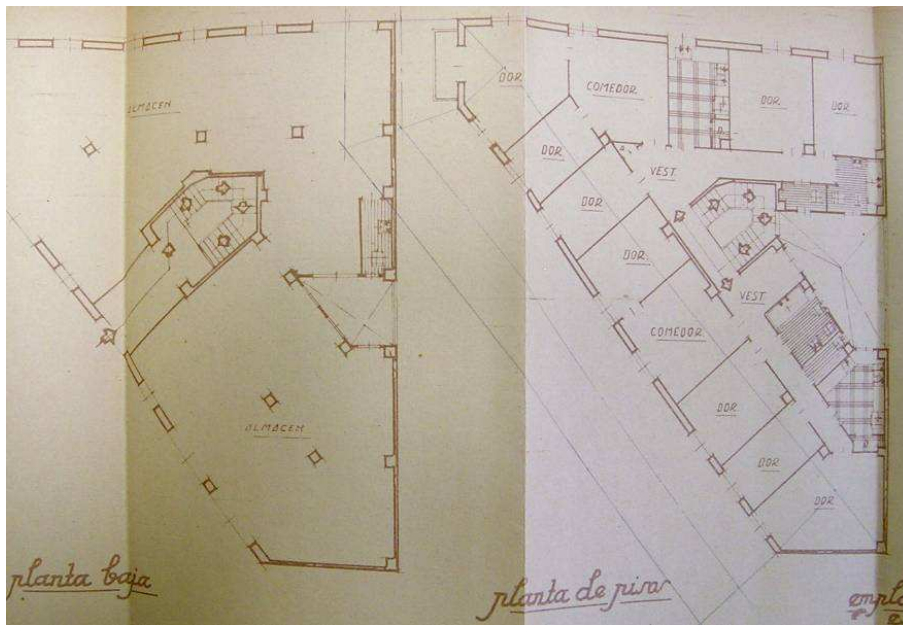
Planta de distribución. Edificio ficha 77ª.022
